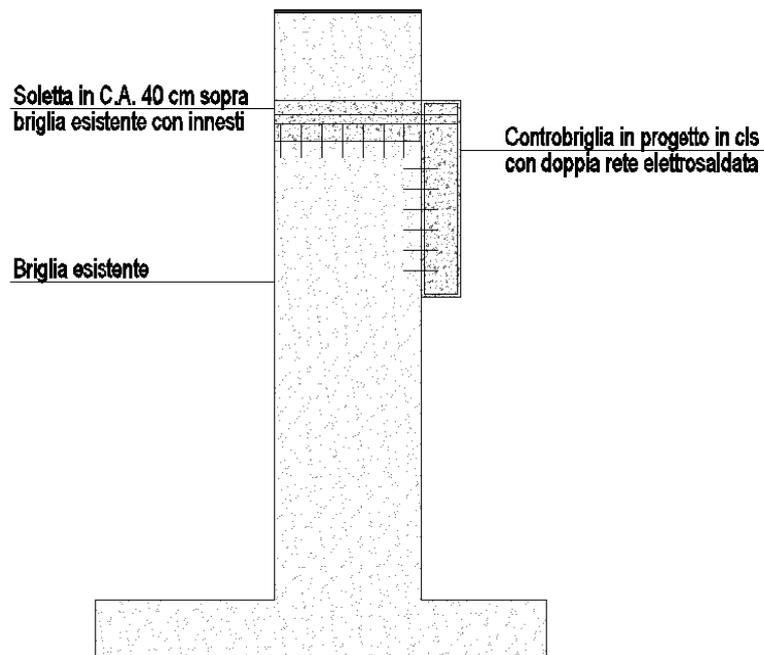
sezione della traversa dove è visibile l'opera di risanamento descritta
